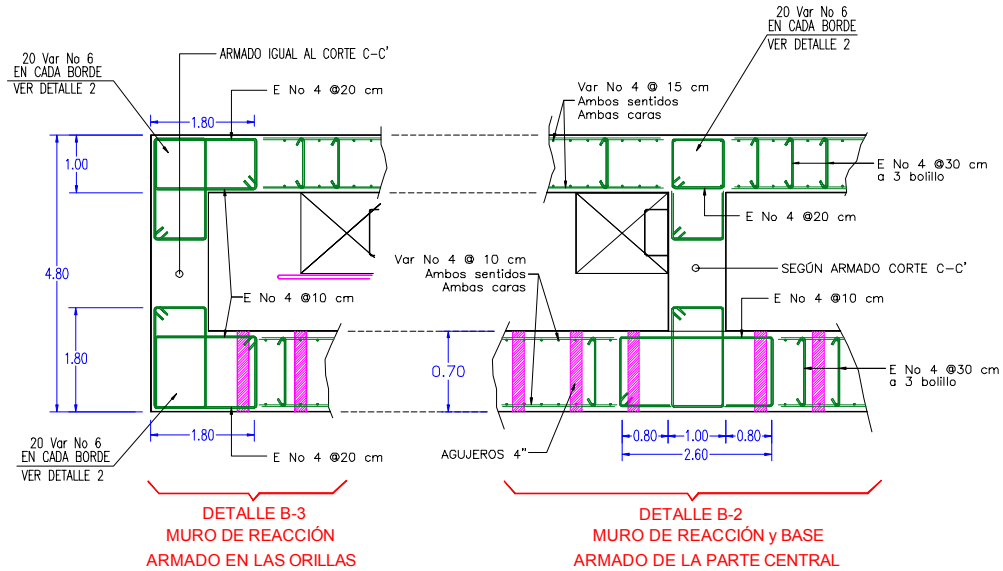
Muestra los armados de orillas y parte central del muro de reacción.
